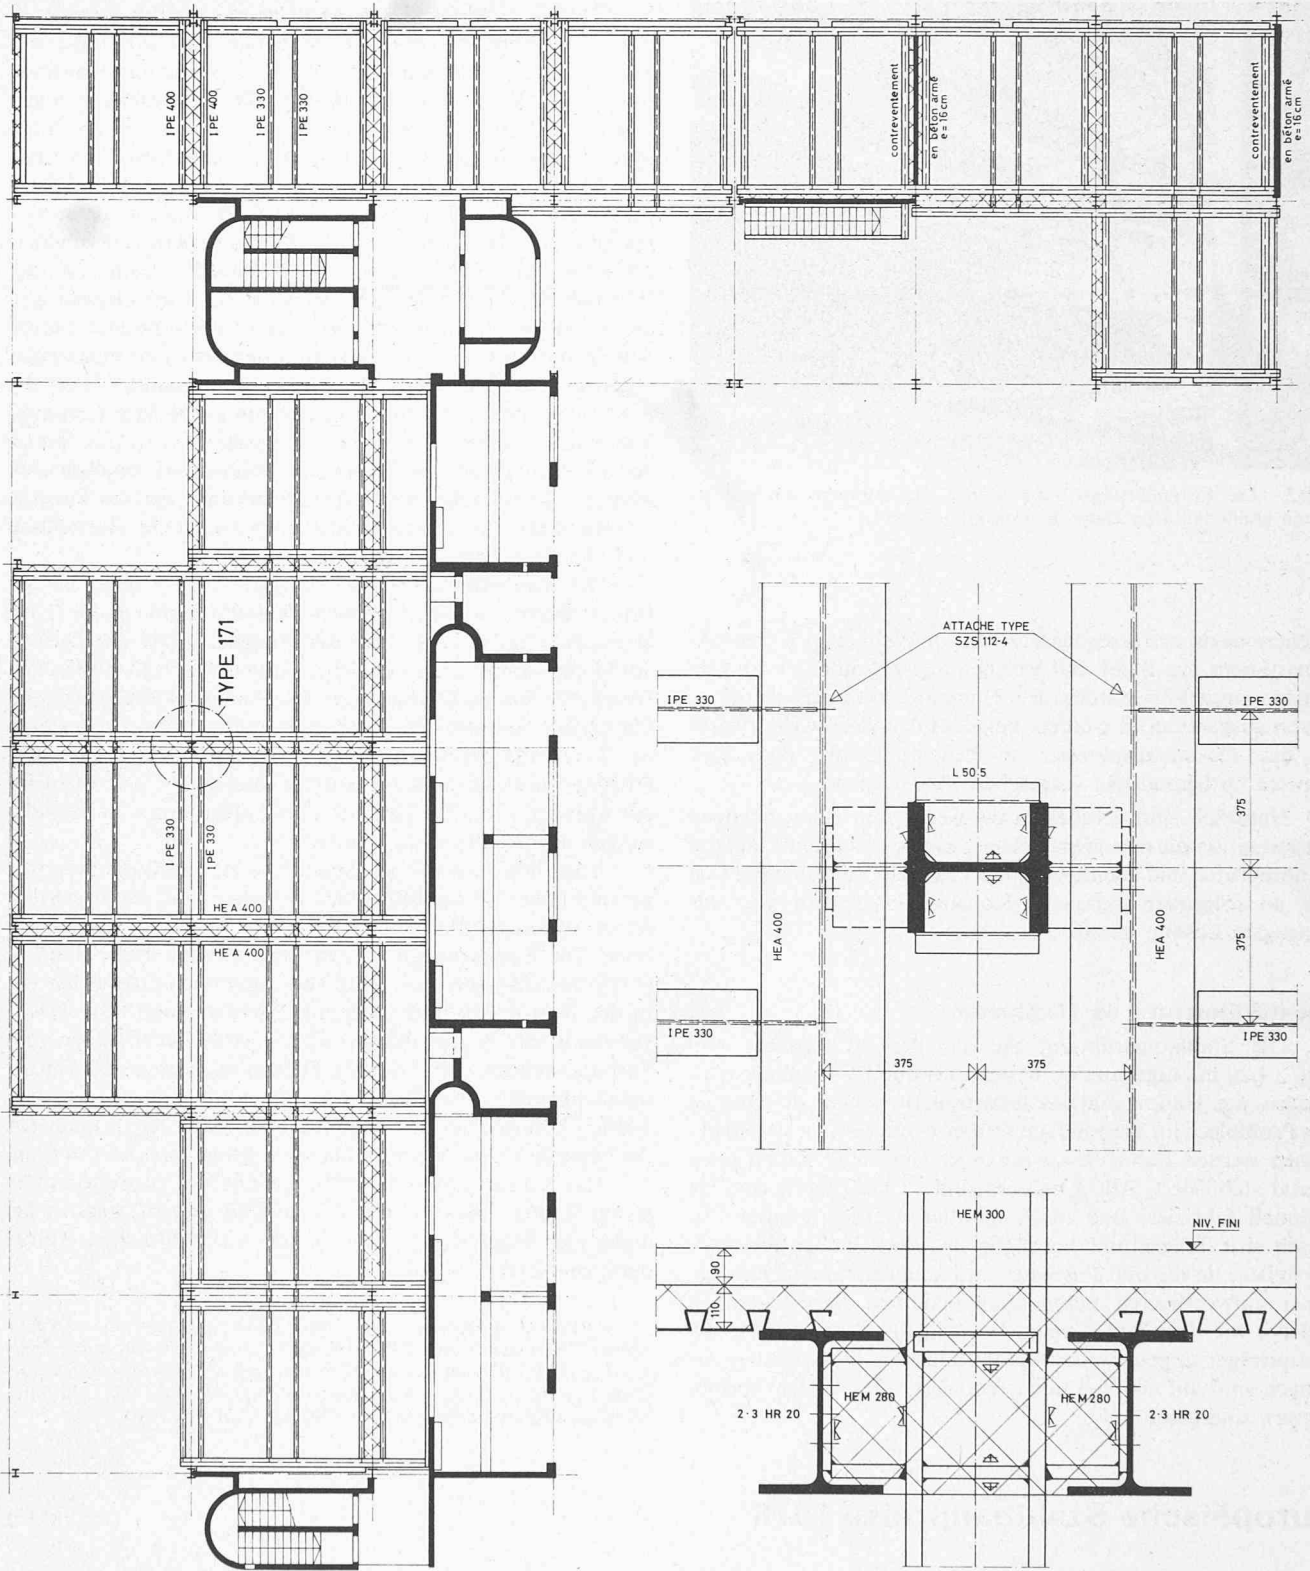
(links). Grundriss der Stahlkonstruktion mit massivem Treppenhaus und Liftkernen sowie einigen massiven Spezialräumen. Rastermass 7,20 x 7,20 m
